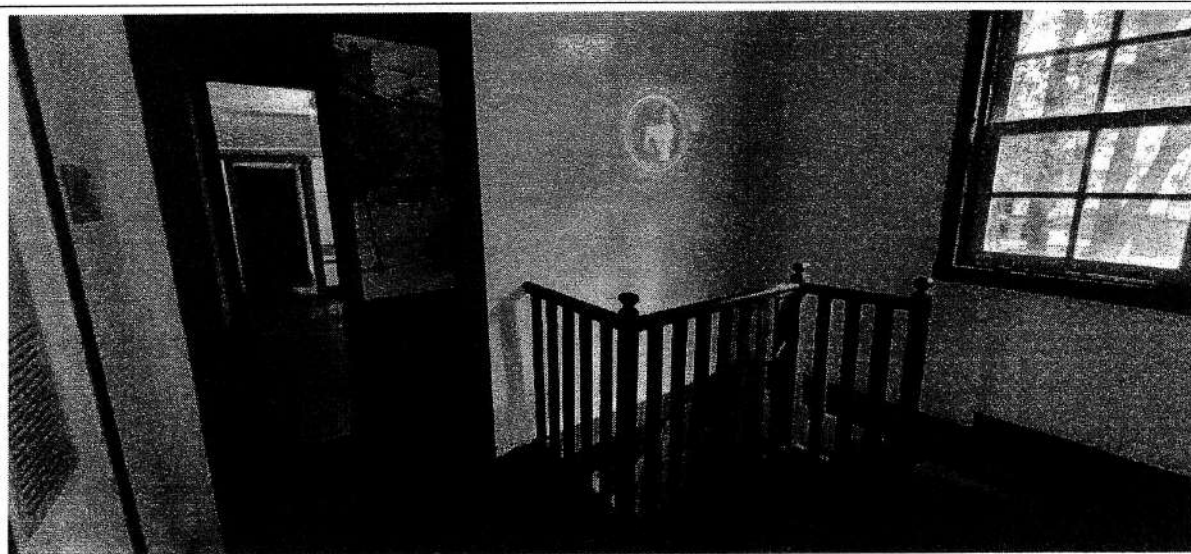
Casarão – 1º pavimento acesso exclusivo por meio de escadas
